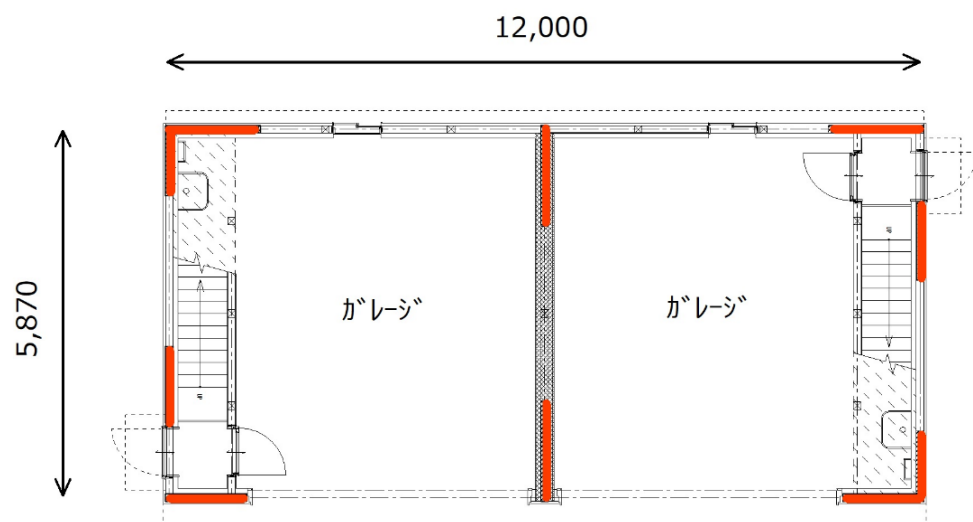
1 階平面図(赤線は CLT 耐力壁を示す)
